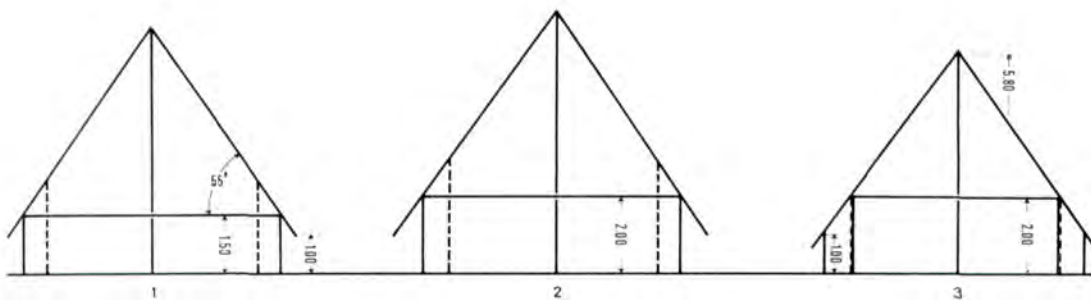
Rekonstruktionen auf den Hausgrundrissen vom Typus Haps. 1 : 200.
